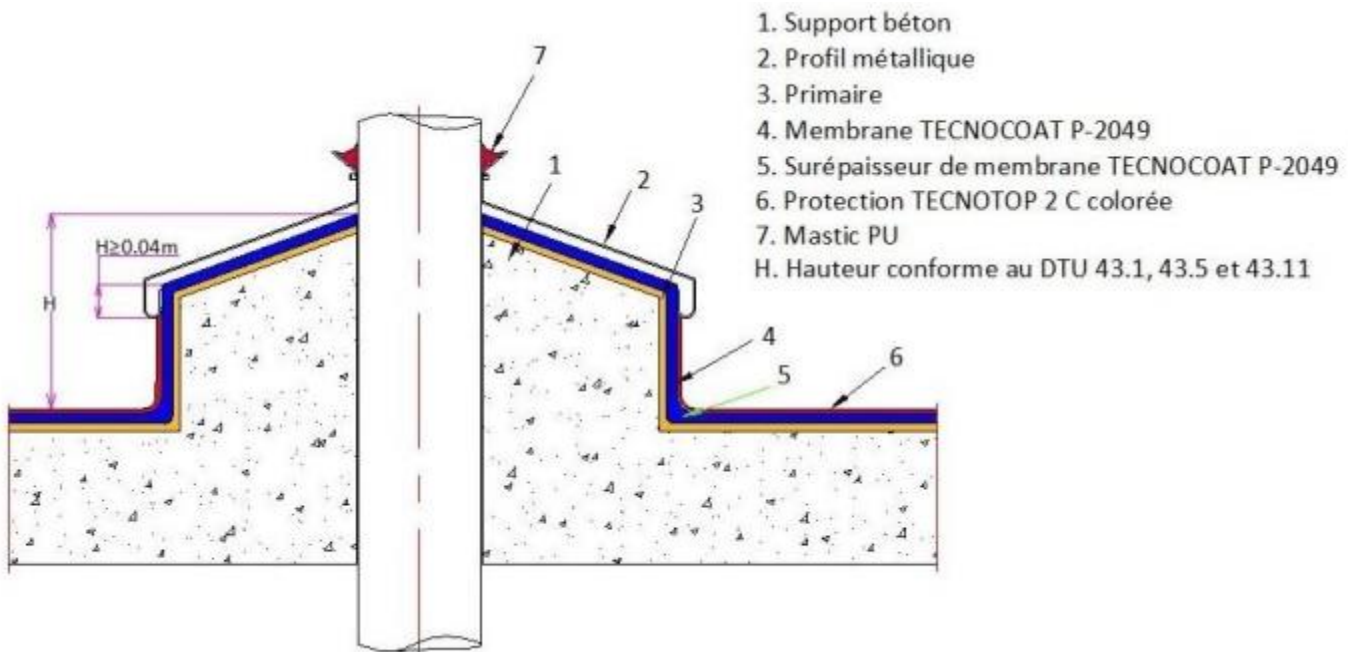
Exemple de traversée d'une canalisation avec un dé en béton
